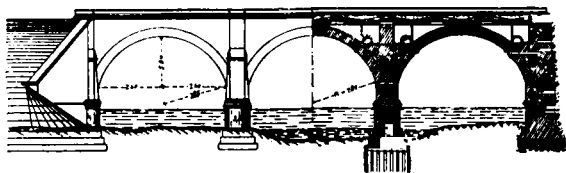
Фасадъ и разрѣзъ устоя съ откосными крыльями.
